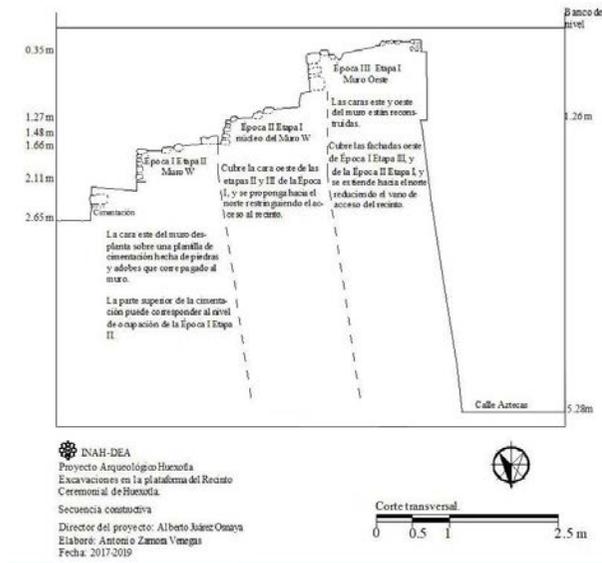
(plano 4) Secuencia constructiva de la plataforma del recinto sagrado, fachada principal. Corte longitudinal.
